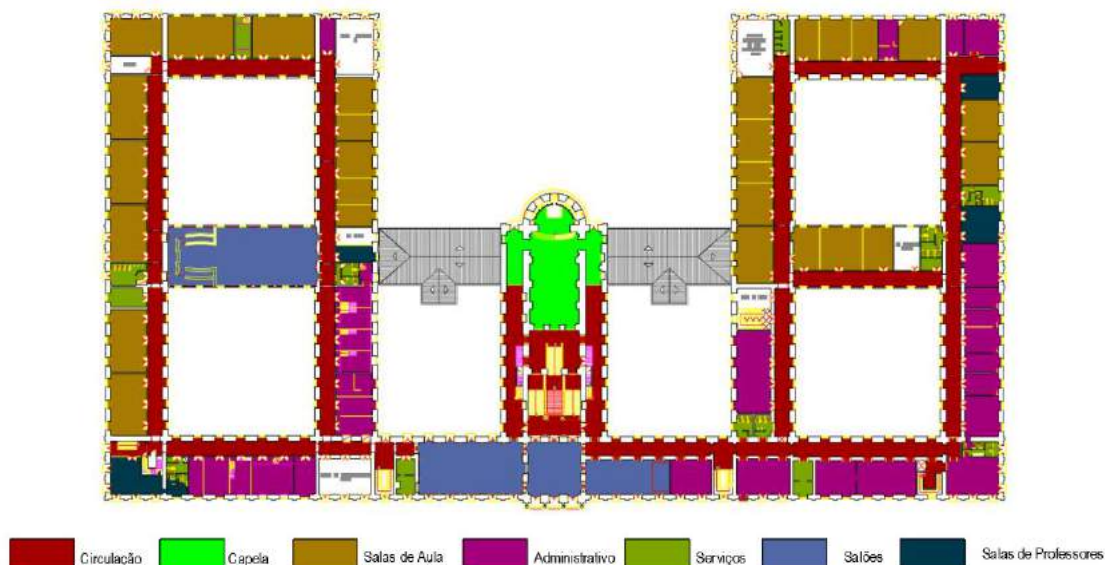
Planta de Uso do 2º pavimento do Palácio universitário /UFRJ – Urca, RJ.
